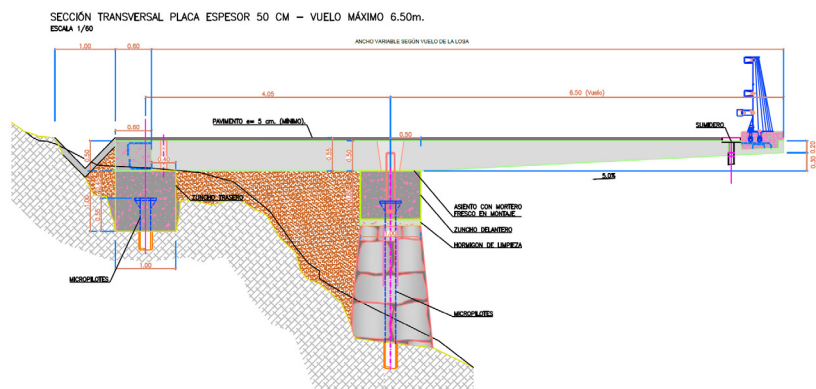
Sección tipo de voladizo para vuelo máximo de 6,5m
